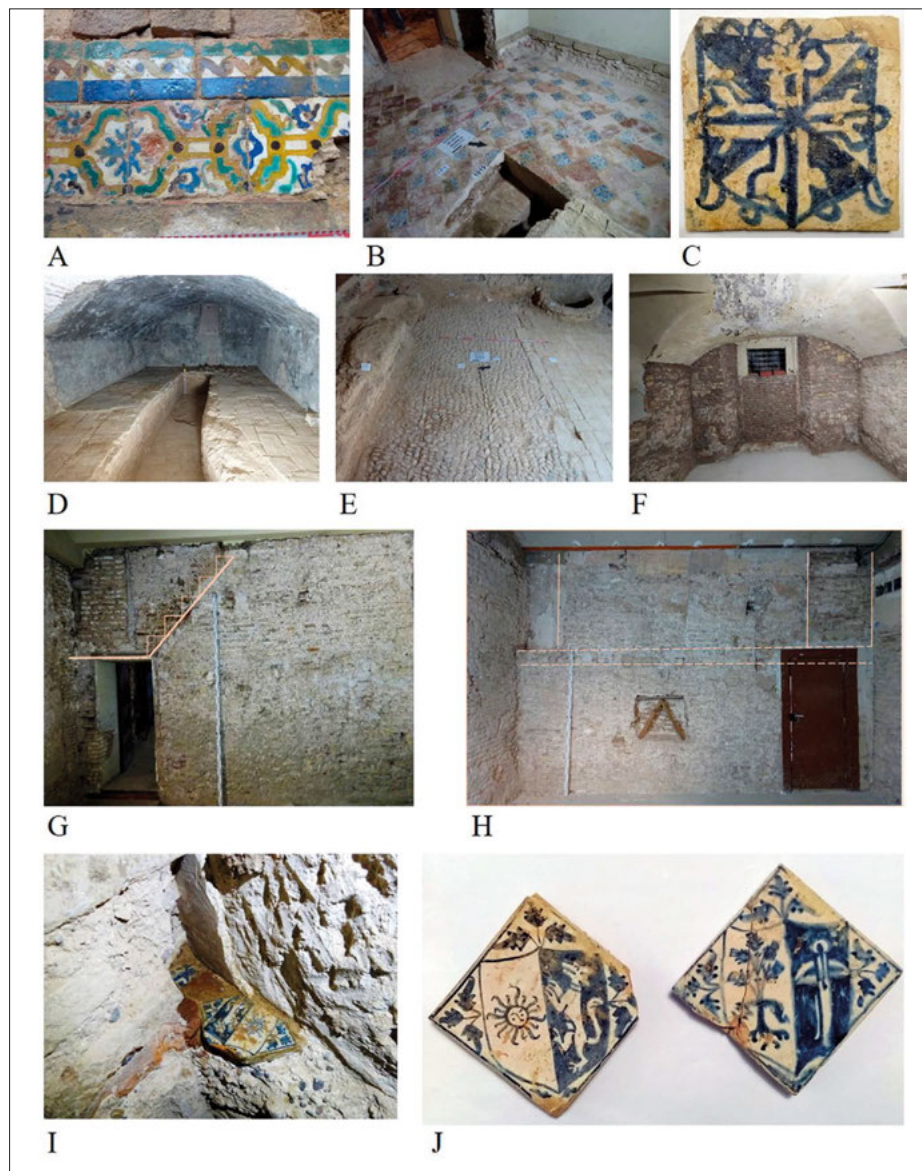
Alquería de Julià. A. Pavimento de azulejos de arista de la puerta principal; B. Sala 1F con pavimento de azulejos y baldosas; C. Azulejo con el escudo de la orden de los Dominicos; D. Despensa subterránea; E. Pavimento de la cuadra; F. Bodega; G. Muro del cuerpo 1A donde se halló el replanteo y rozas de la escalera de subida a la entreplanta y piso superior de la alquería; H. Detalle del muro del cuerpo 1D con los restos de los mechinales para el forjado del entresuelo y puertas de esa planta; I. Detalle de pavimento de la puerta en esviaje de la entreplanta; J. Azulejos heráldicos recuperados en la intervención arqueológica.
